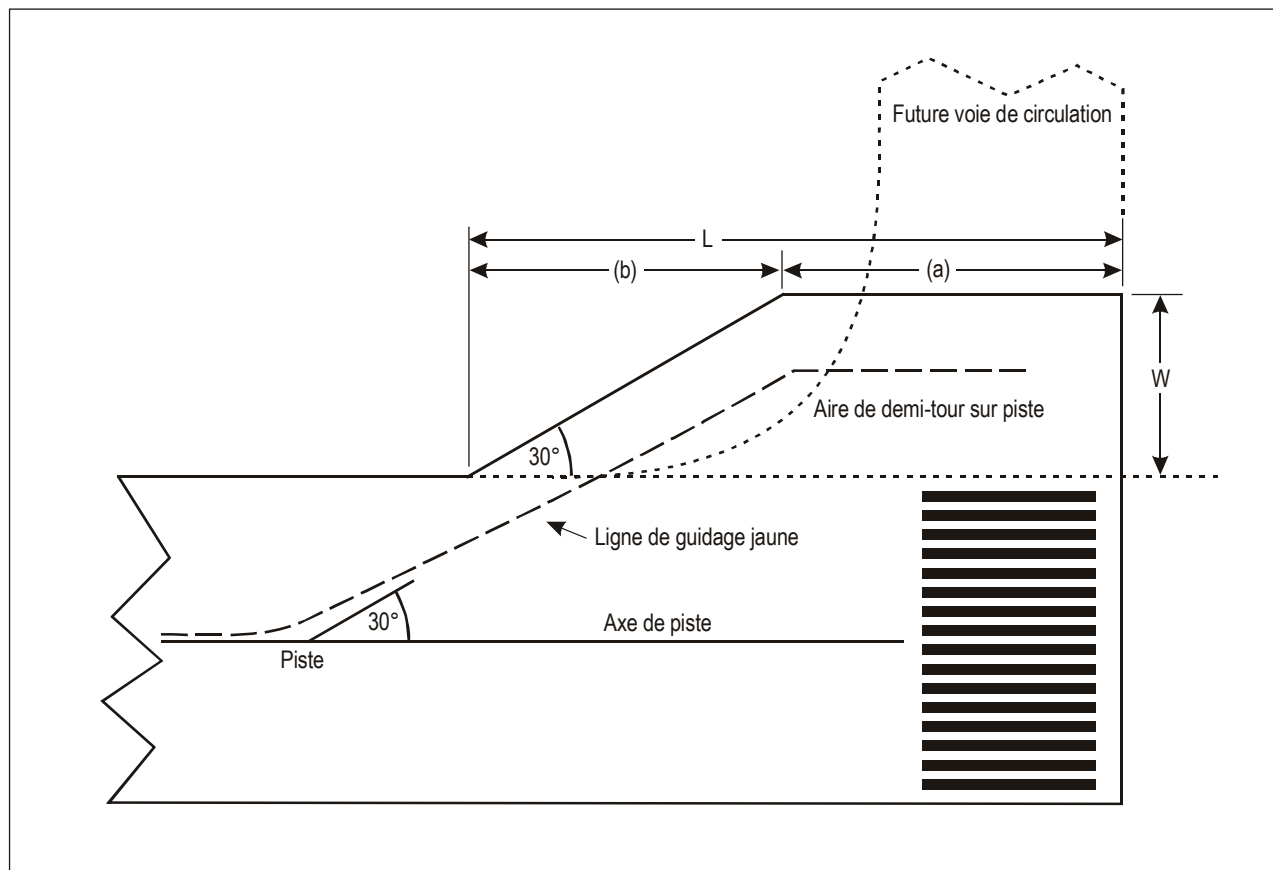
Plan type d'une aire de demi-tour sur piste
